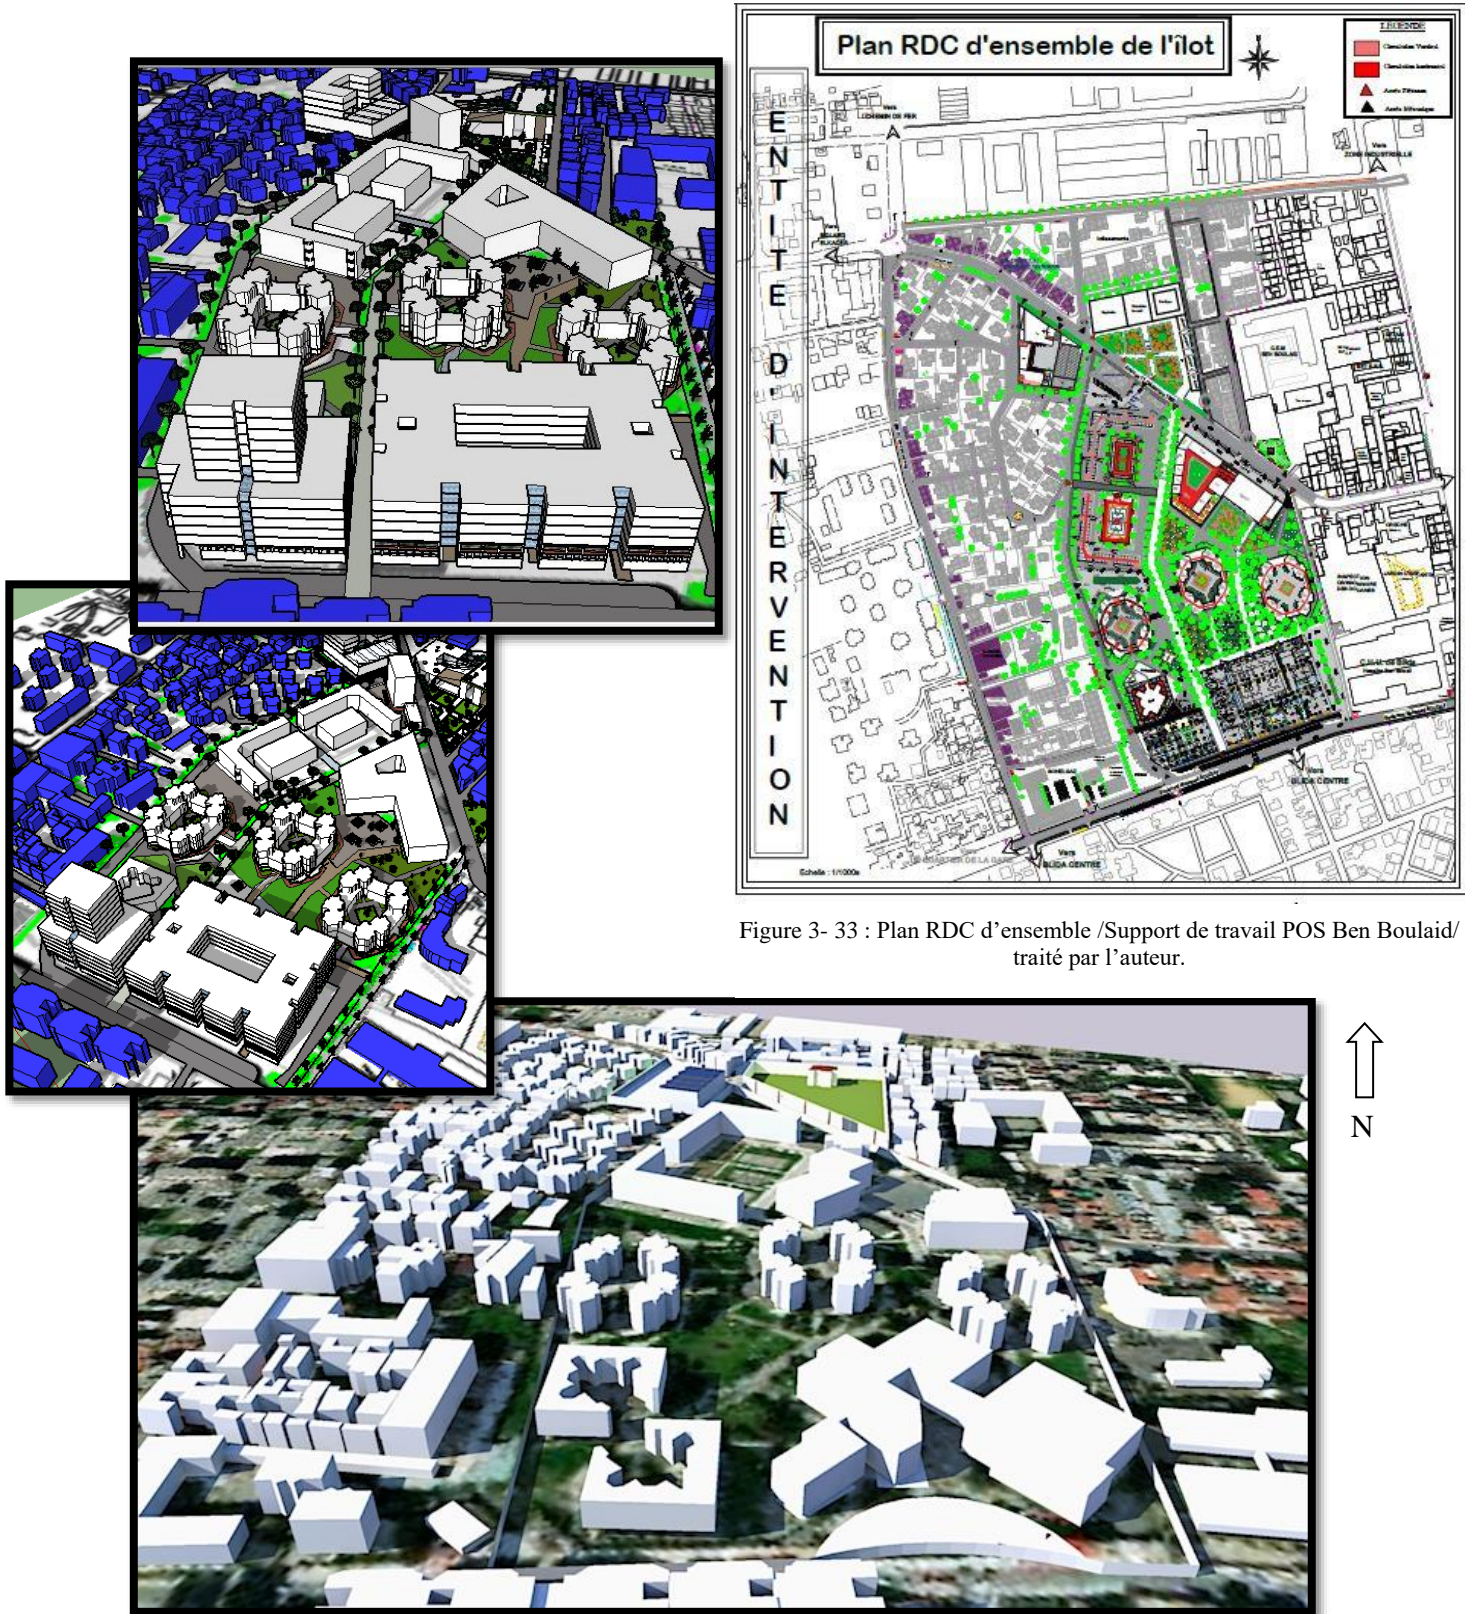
33 : Plan RDC d'ensemble /Support de travail POS Ben Boulaid/ traité par l'auteur.
